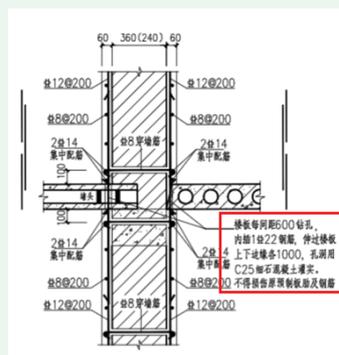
钢筋混凝土面层竖向钢筋在楼面板处连接做法（预制板）
